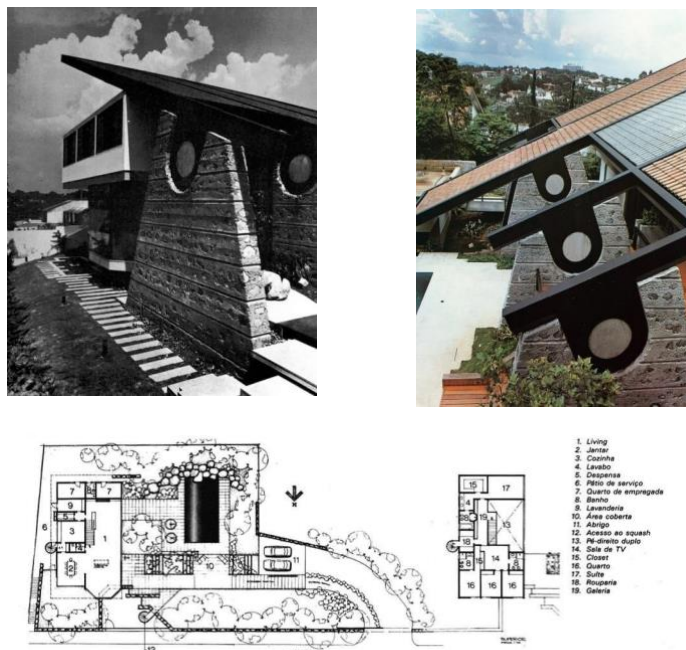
, 12, 13, 14 e 15: Perspectiva, plantas e corte. (Fonte: PROJETO, 2020)
